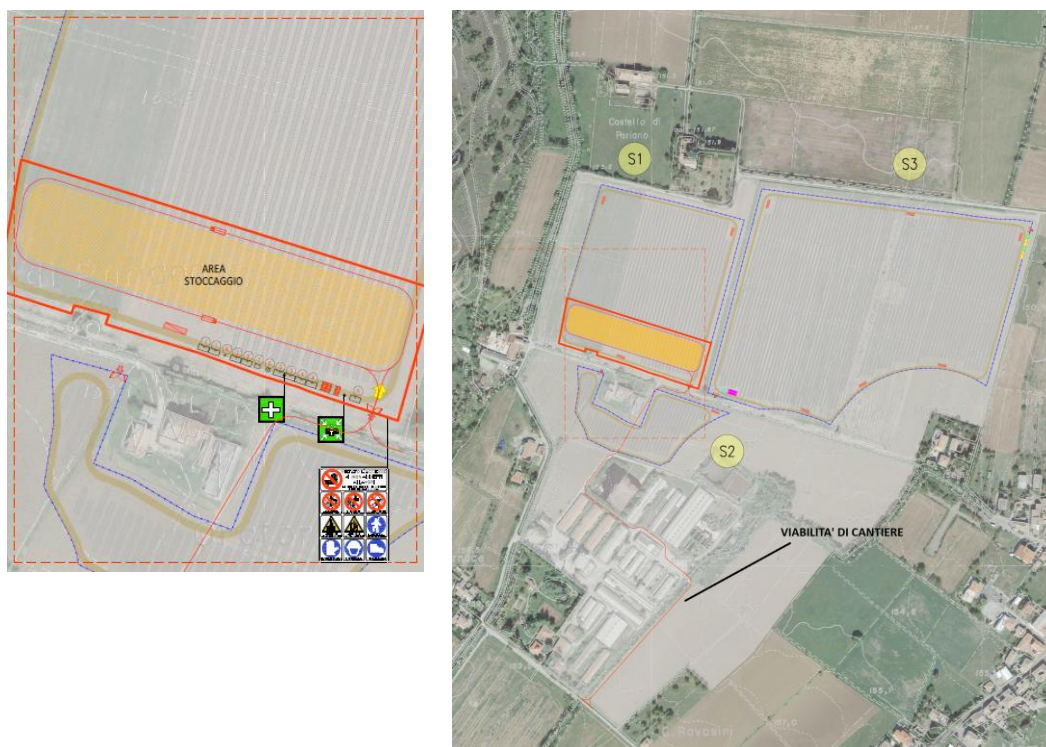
Stralcio delle aree di stoccaggio di cantiere.
